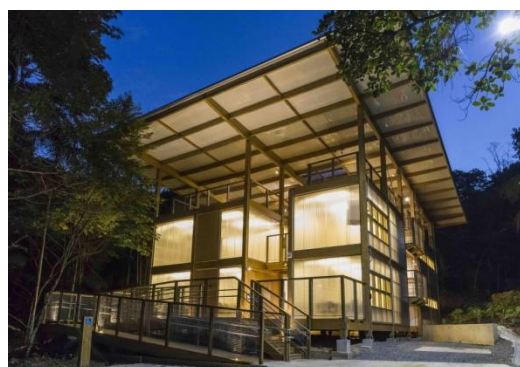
Edifício da Fundação Florestal em Peruíbe-SP – MLC da REWOOD. Fonte: site REWOOD
